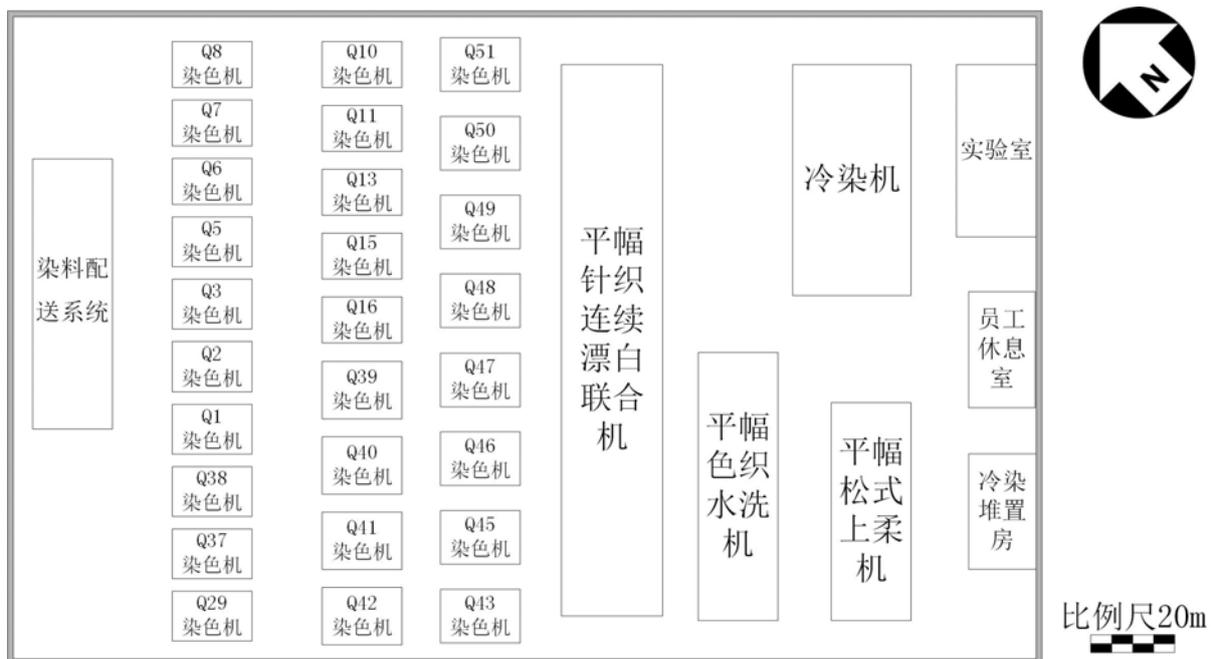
数字化绿色厂房 3F 平面布置示意图（新增）
